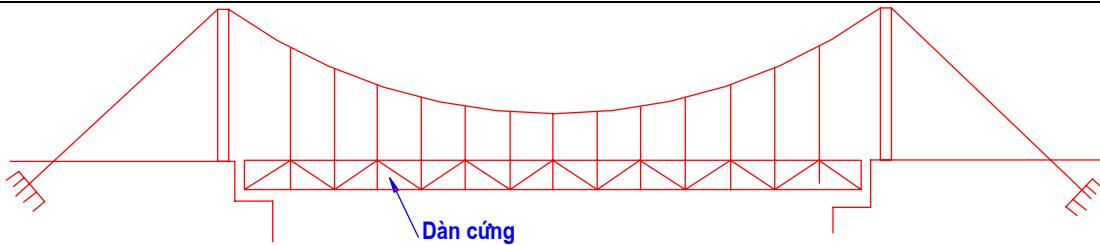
Sơ đồ cầu treo có bố trí khớp dọc
